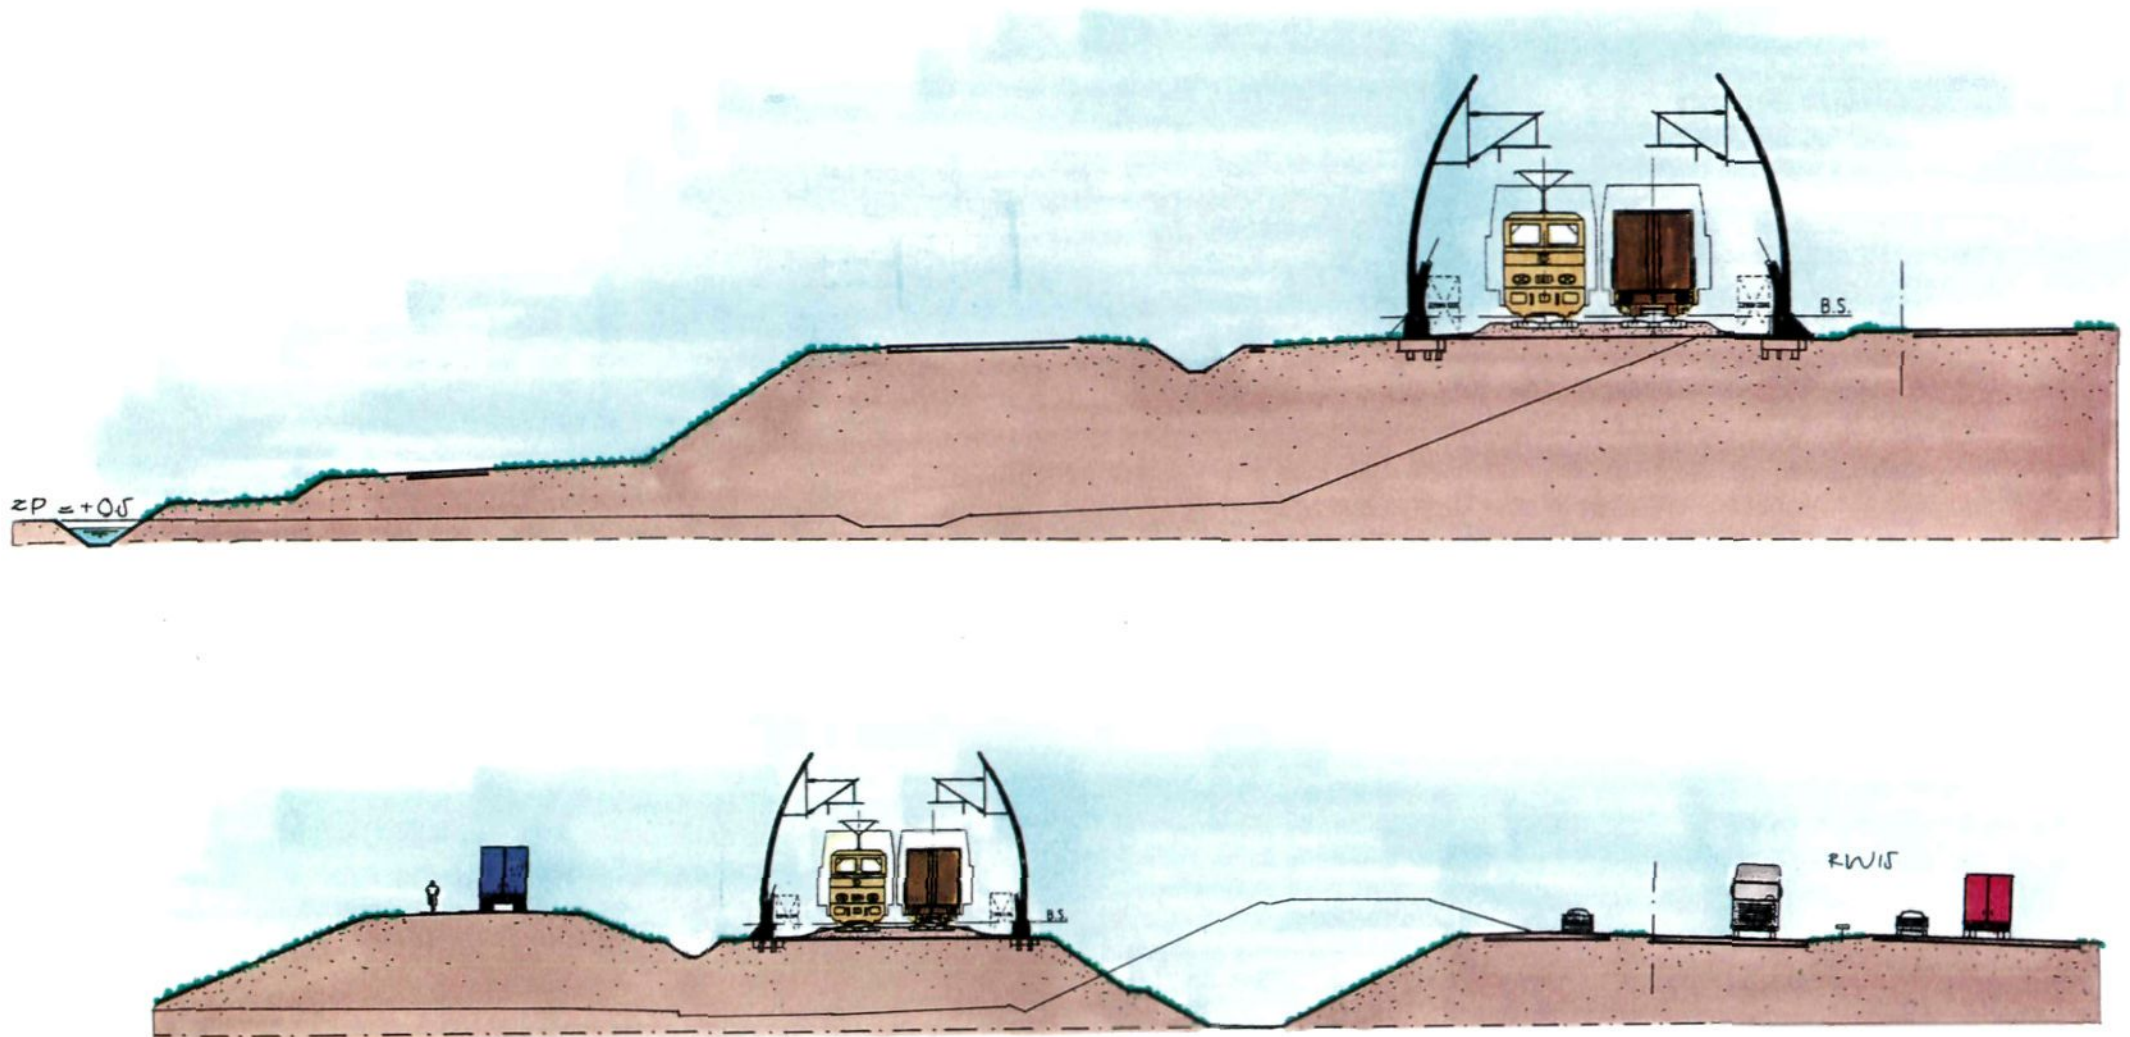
Plantekening van de Betuweroute voor het deel tussen km 27,2 en 27,625
